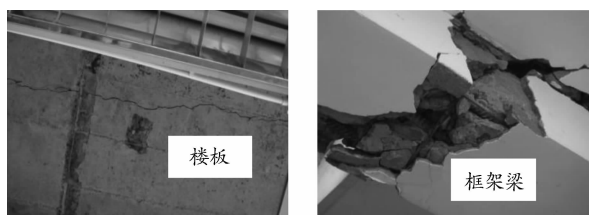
都江堰市某办公楼内部钢筋混凝土构件破坏情况
